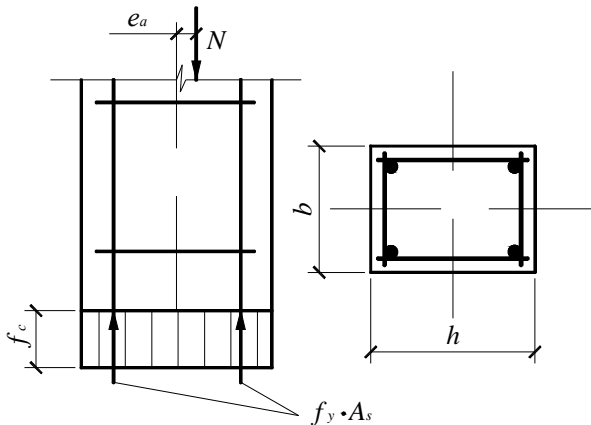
Розрахункова схема перерізу нормального до поздовжньої осі при стисненні з випадковим ексцентриситетом
